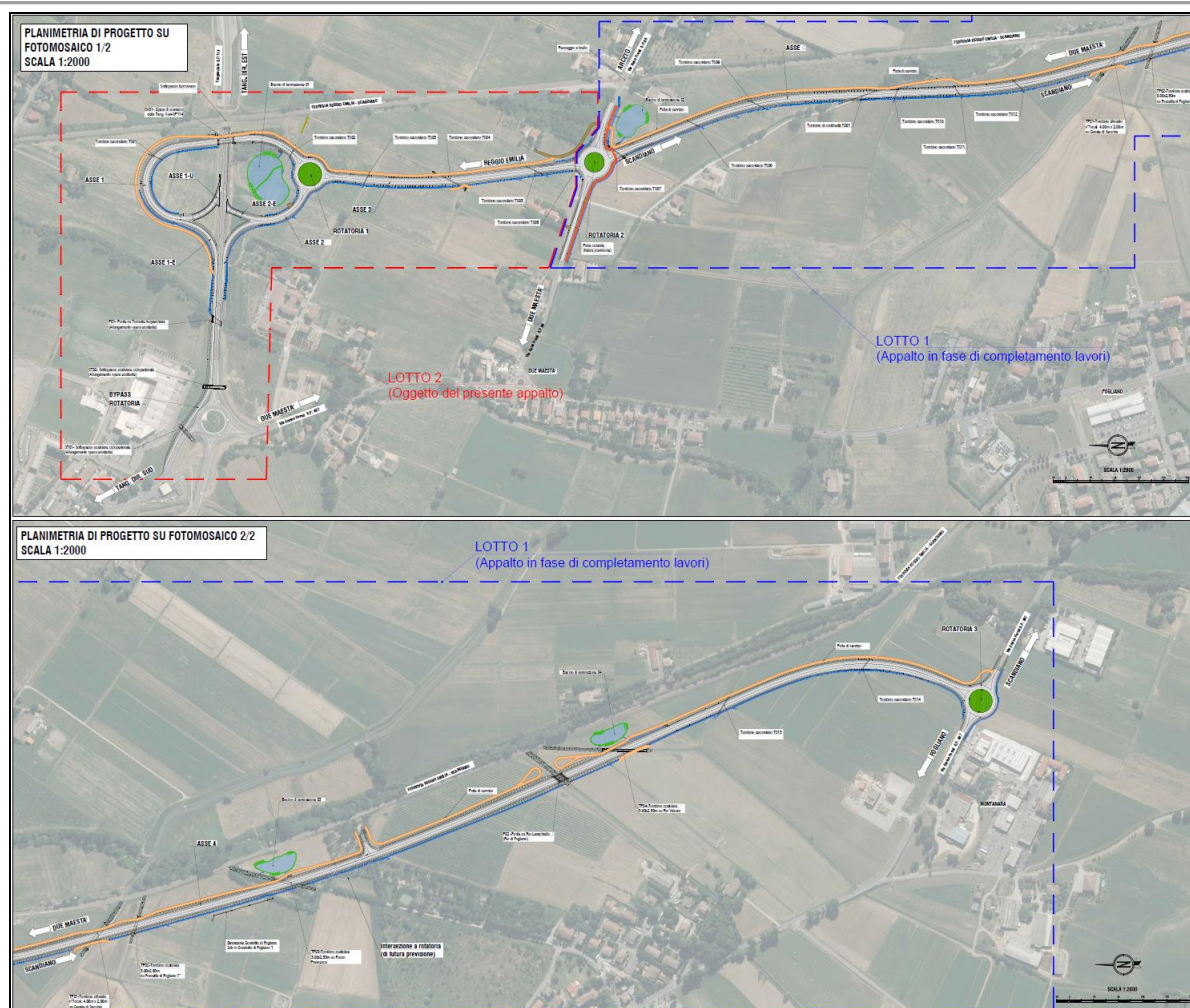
Stralcio di planimetria generale su ortofoto
